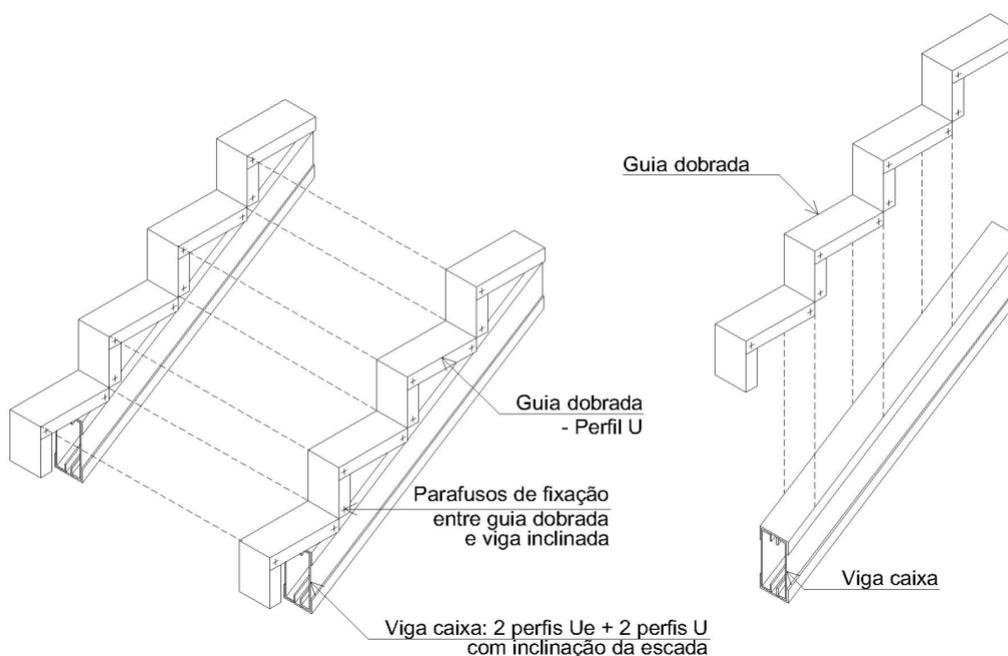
Desenho esquemático de escada viga caixa inclinada
